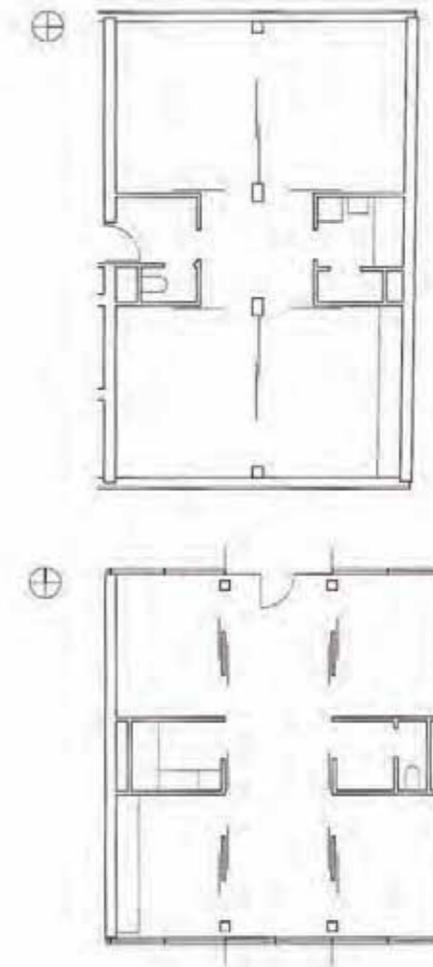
Flexible Grundrisse nach Architekt Helmut Wimmer
